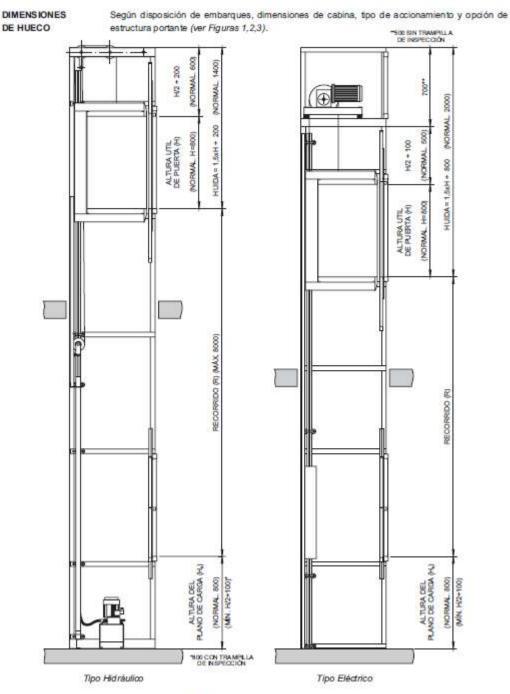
Dimensiones Minimas de Hueco en Alzado.
